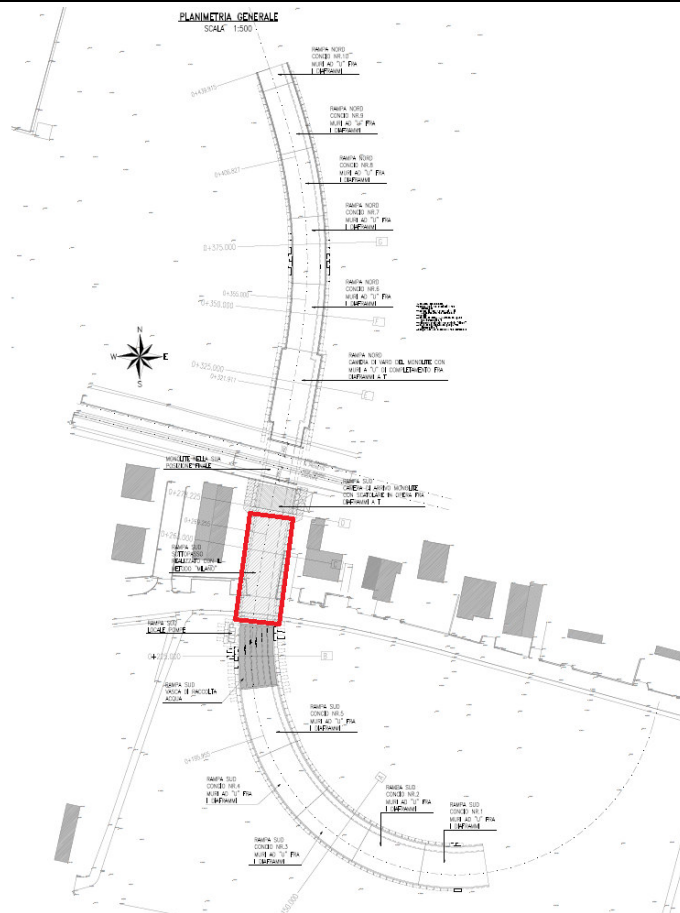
planimetria generale del sottopasso SL02 con il tratto interessato evidenziato
